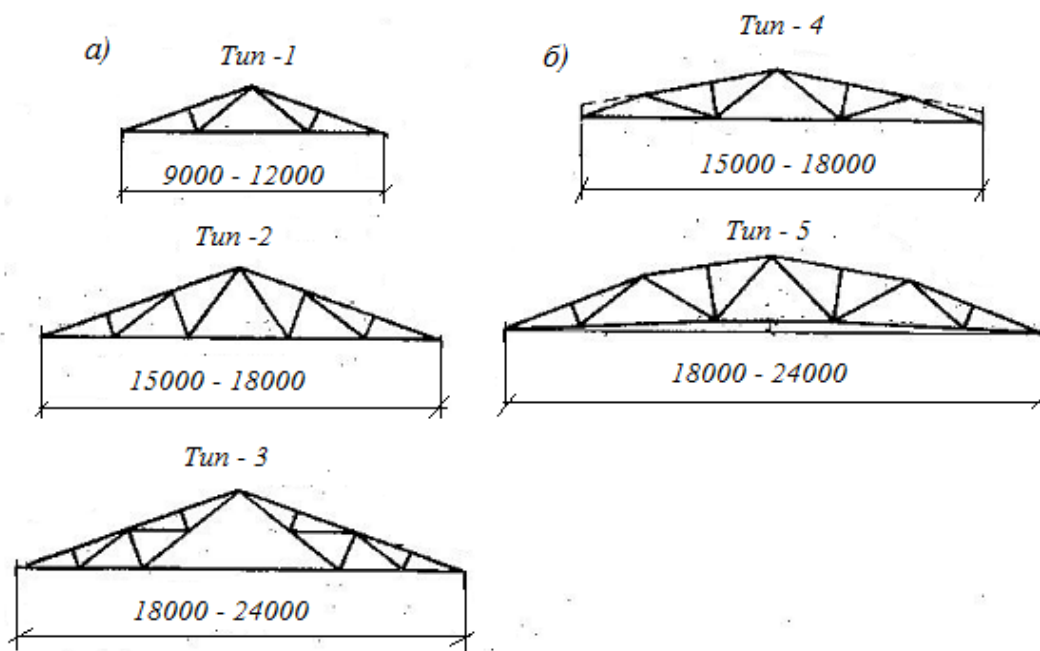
Геометрические схемы металлодеревянных ферм с брусчатым верхним поясом а) – треугольные; б) – пятиугольные
